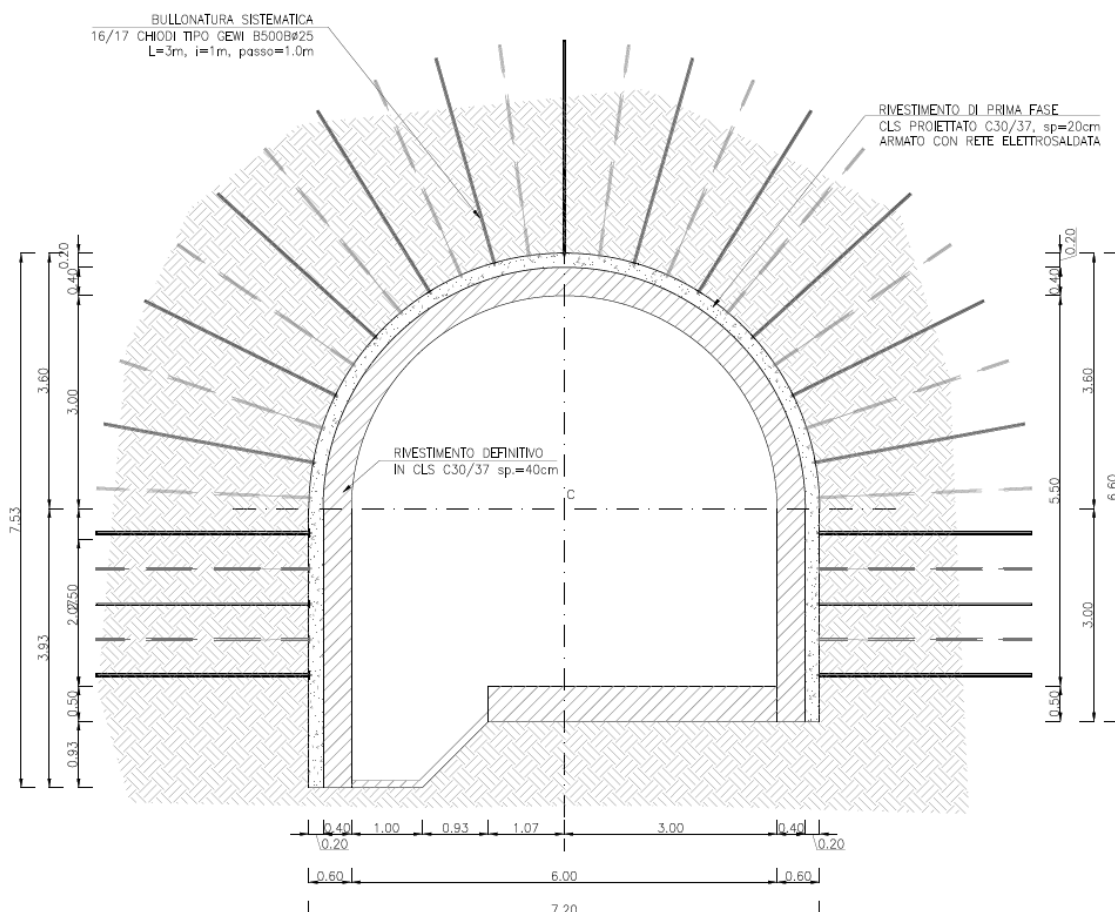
Sezione tipo GV-1: geometria del cavo e interventi di sostegno
